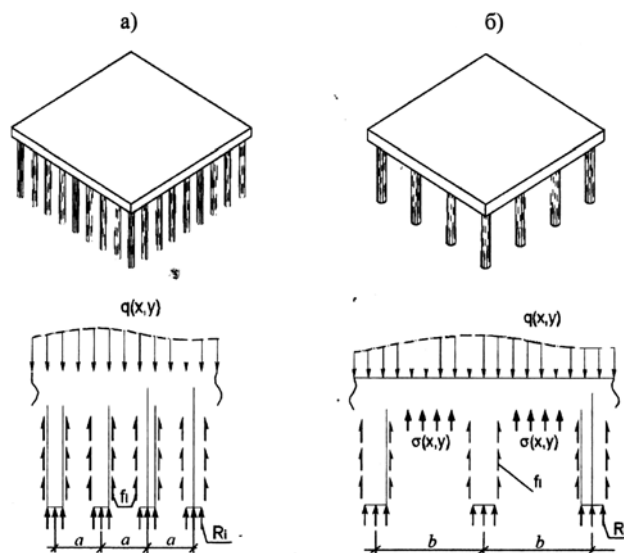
Схемы работы свайного и комбинированного свайно-плитного фундамента: а — свайный фундамент; б — комбинированный свайно-плитный фундамент (КСП) [6]
